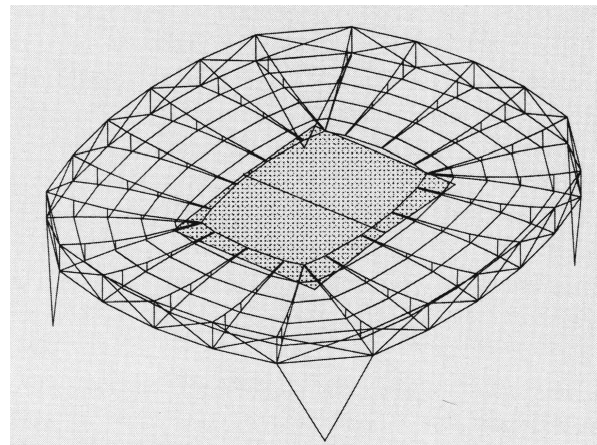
Grundriss des Center-Court in Halle; aus /3/
